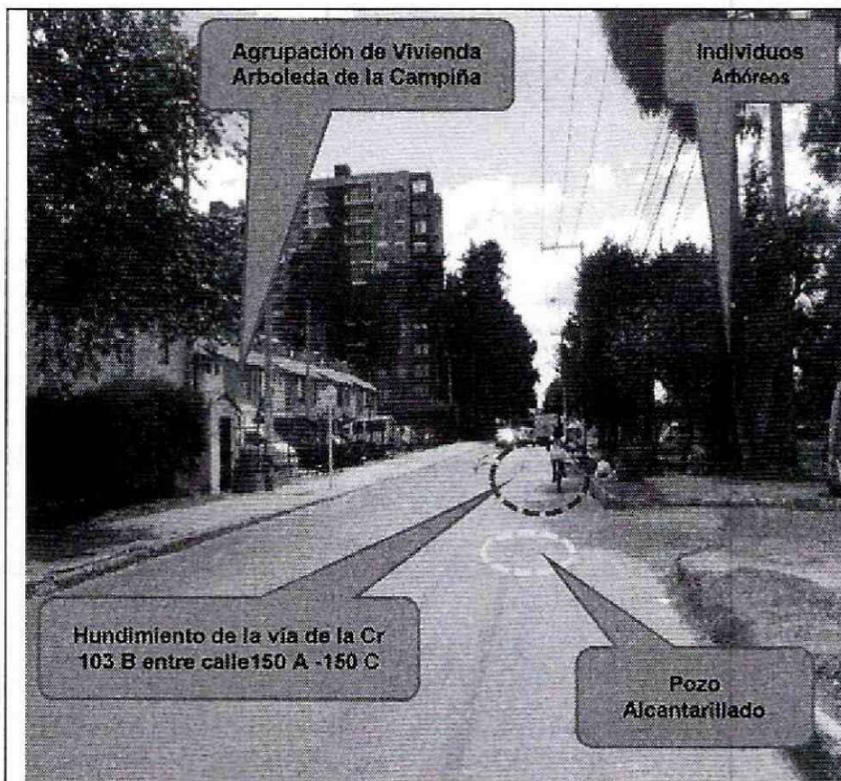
Detalle del hundimiento de la Carrera. 103B sentido Norte a Sur.
